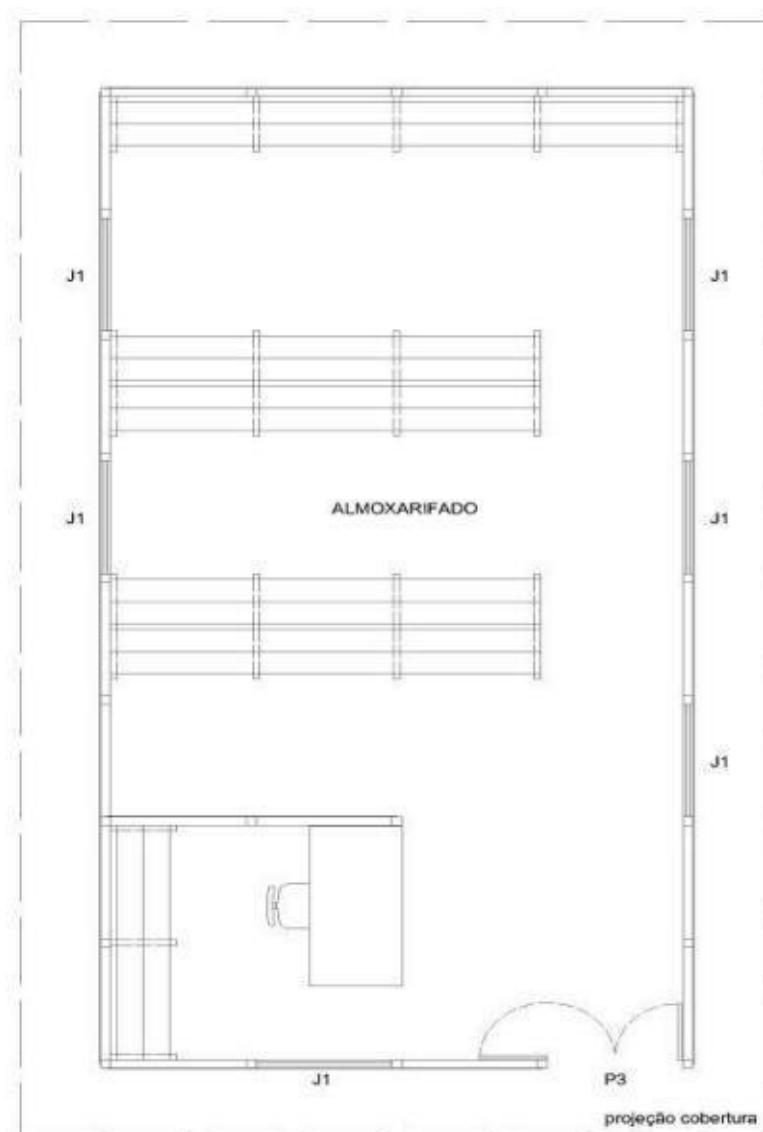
Layout de referência de almoxarifado em canteiro de obra, em chapa compensada, utilizado para fins de especificação. Fonte: Caderno Técnico de Composições para "Instalações para Canteiros de Obras" – SINAPI(aferição 12/2016, atualização 05/2021).
